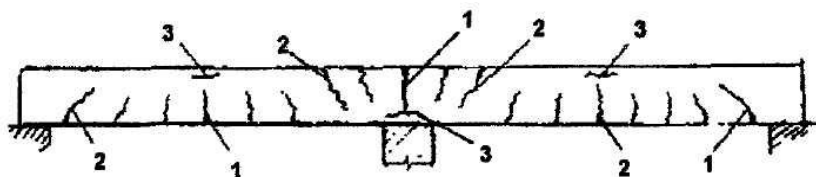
Схема трещин в растянутой и сжатой зонах в статически неопределяемом изгибаемом железобетонном элементе:
